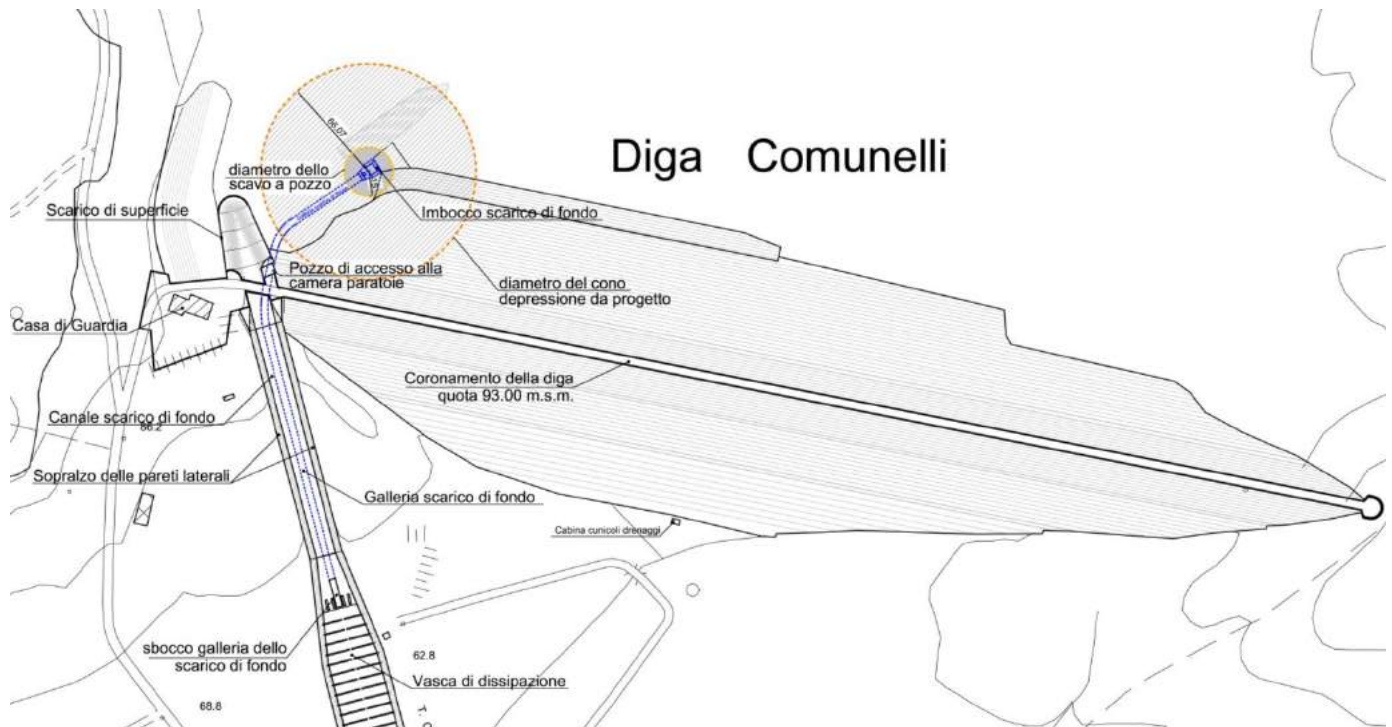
Planimetria delle opere di scarico con indicazione dell'area di rimozione del sedimento
